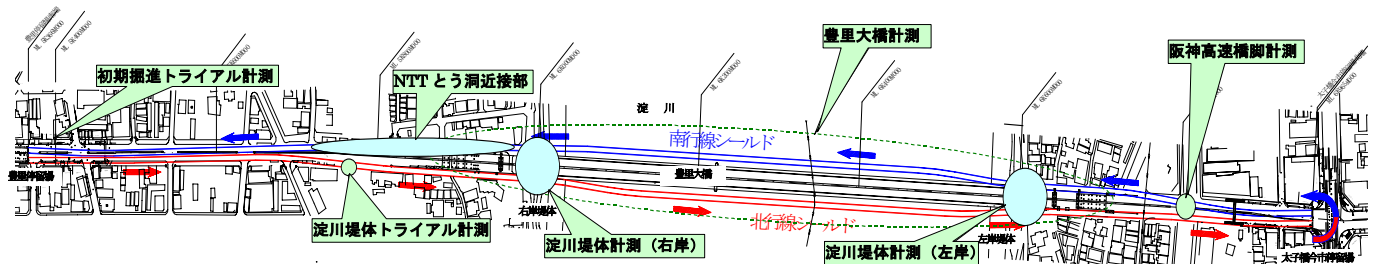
地下鉄第8号線豊里～太子橋今市間路線平面図
